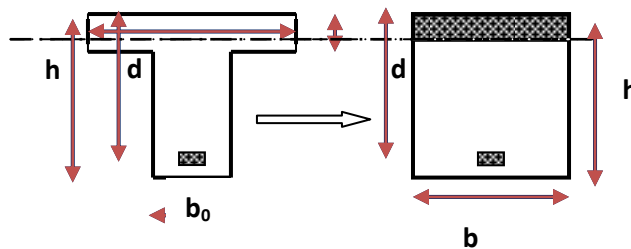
Coupe de Section Rectangulaire et Section en T.
